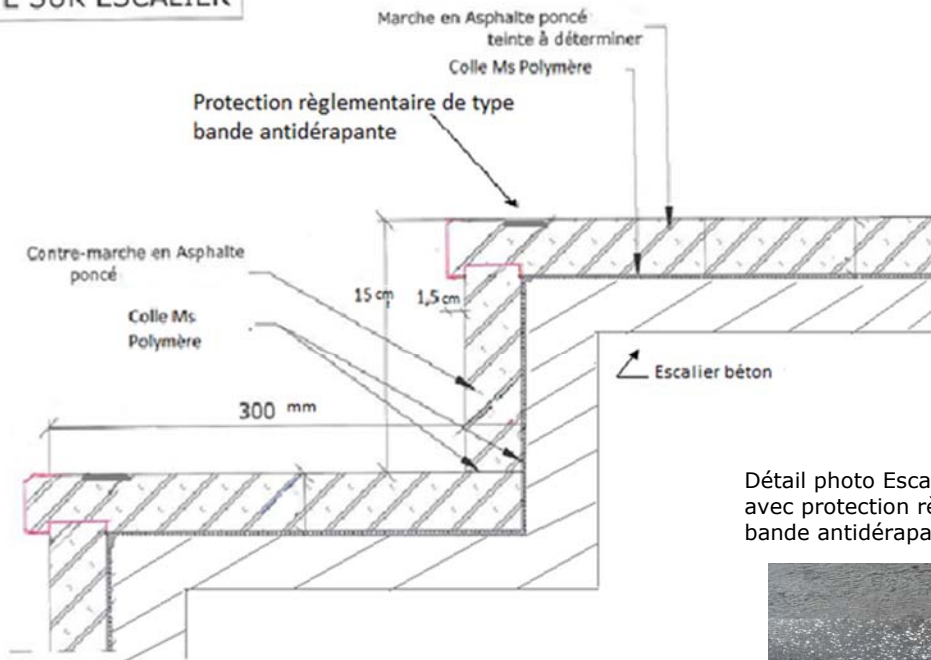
Traitement de l'escalier en NÉOPHALTE® DÉCOR – Exemple de mise en œuvre sur support béton de marches et contremarches préfabriquées
